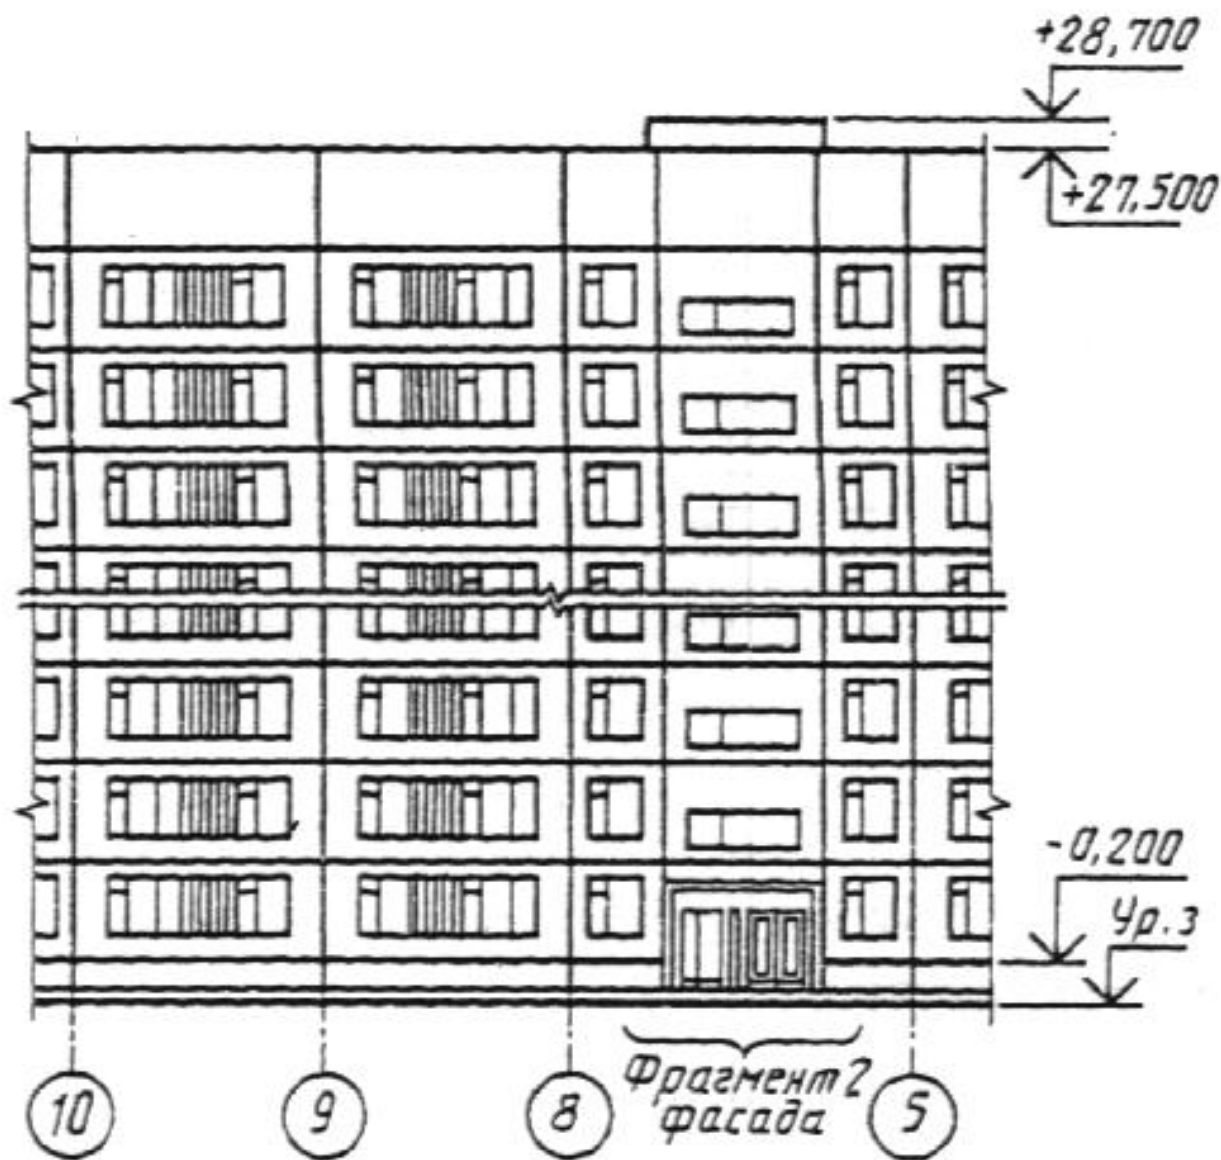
Пример выполнения фасада панельного многоэтажного жилого дома
